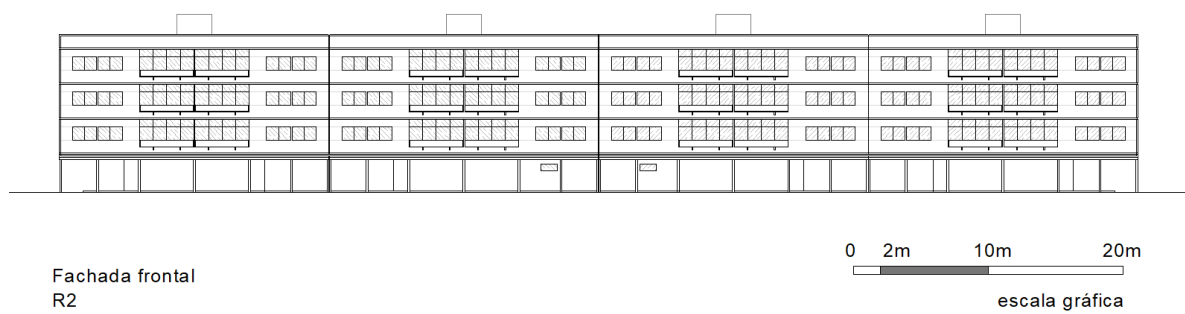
Fachada frontal do R2. Fonte: da autora, adaptado das pranchas originais do Acervo do Arquiteto Milton Ramos.
